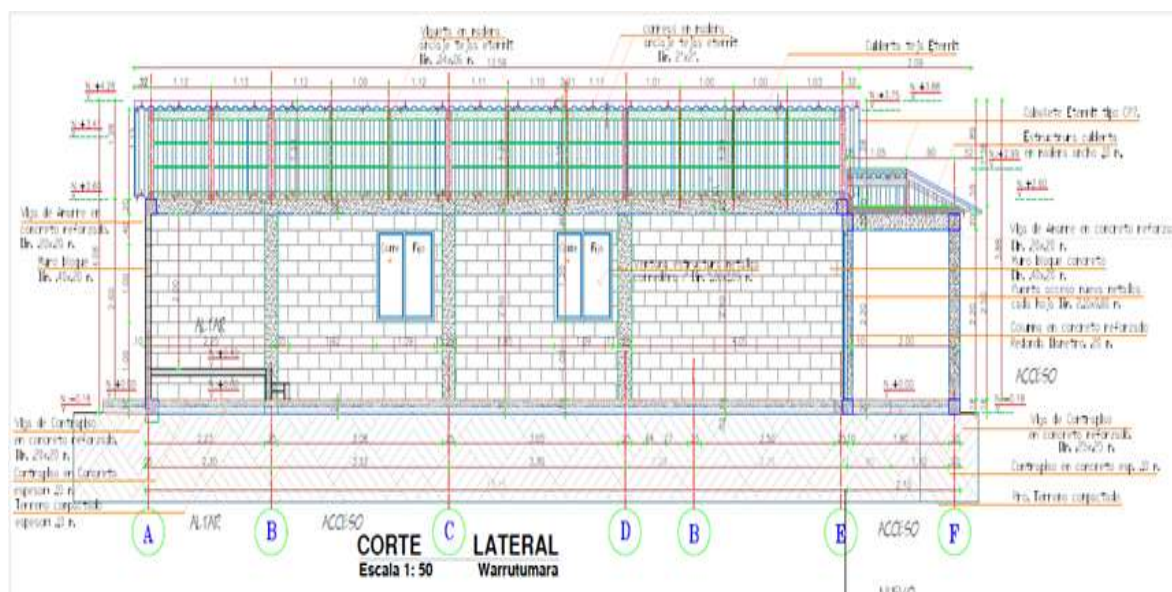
Plano Estructural de la Cubierta en Comunidad Warrutamana.
